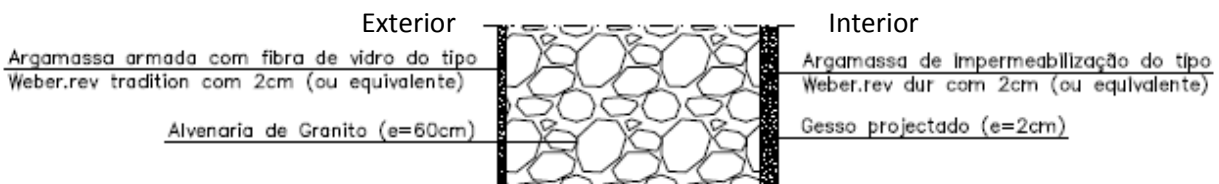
Pormenor construtivo da parede Pe5 [17]
